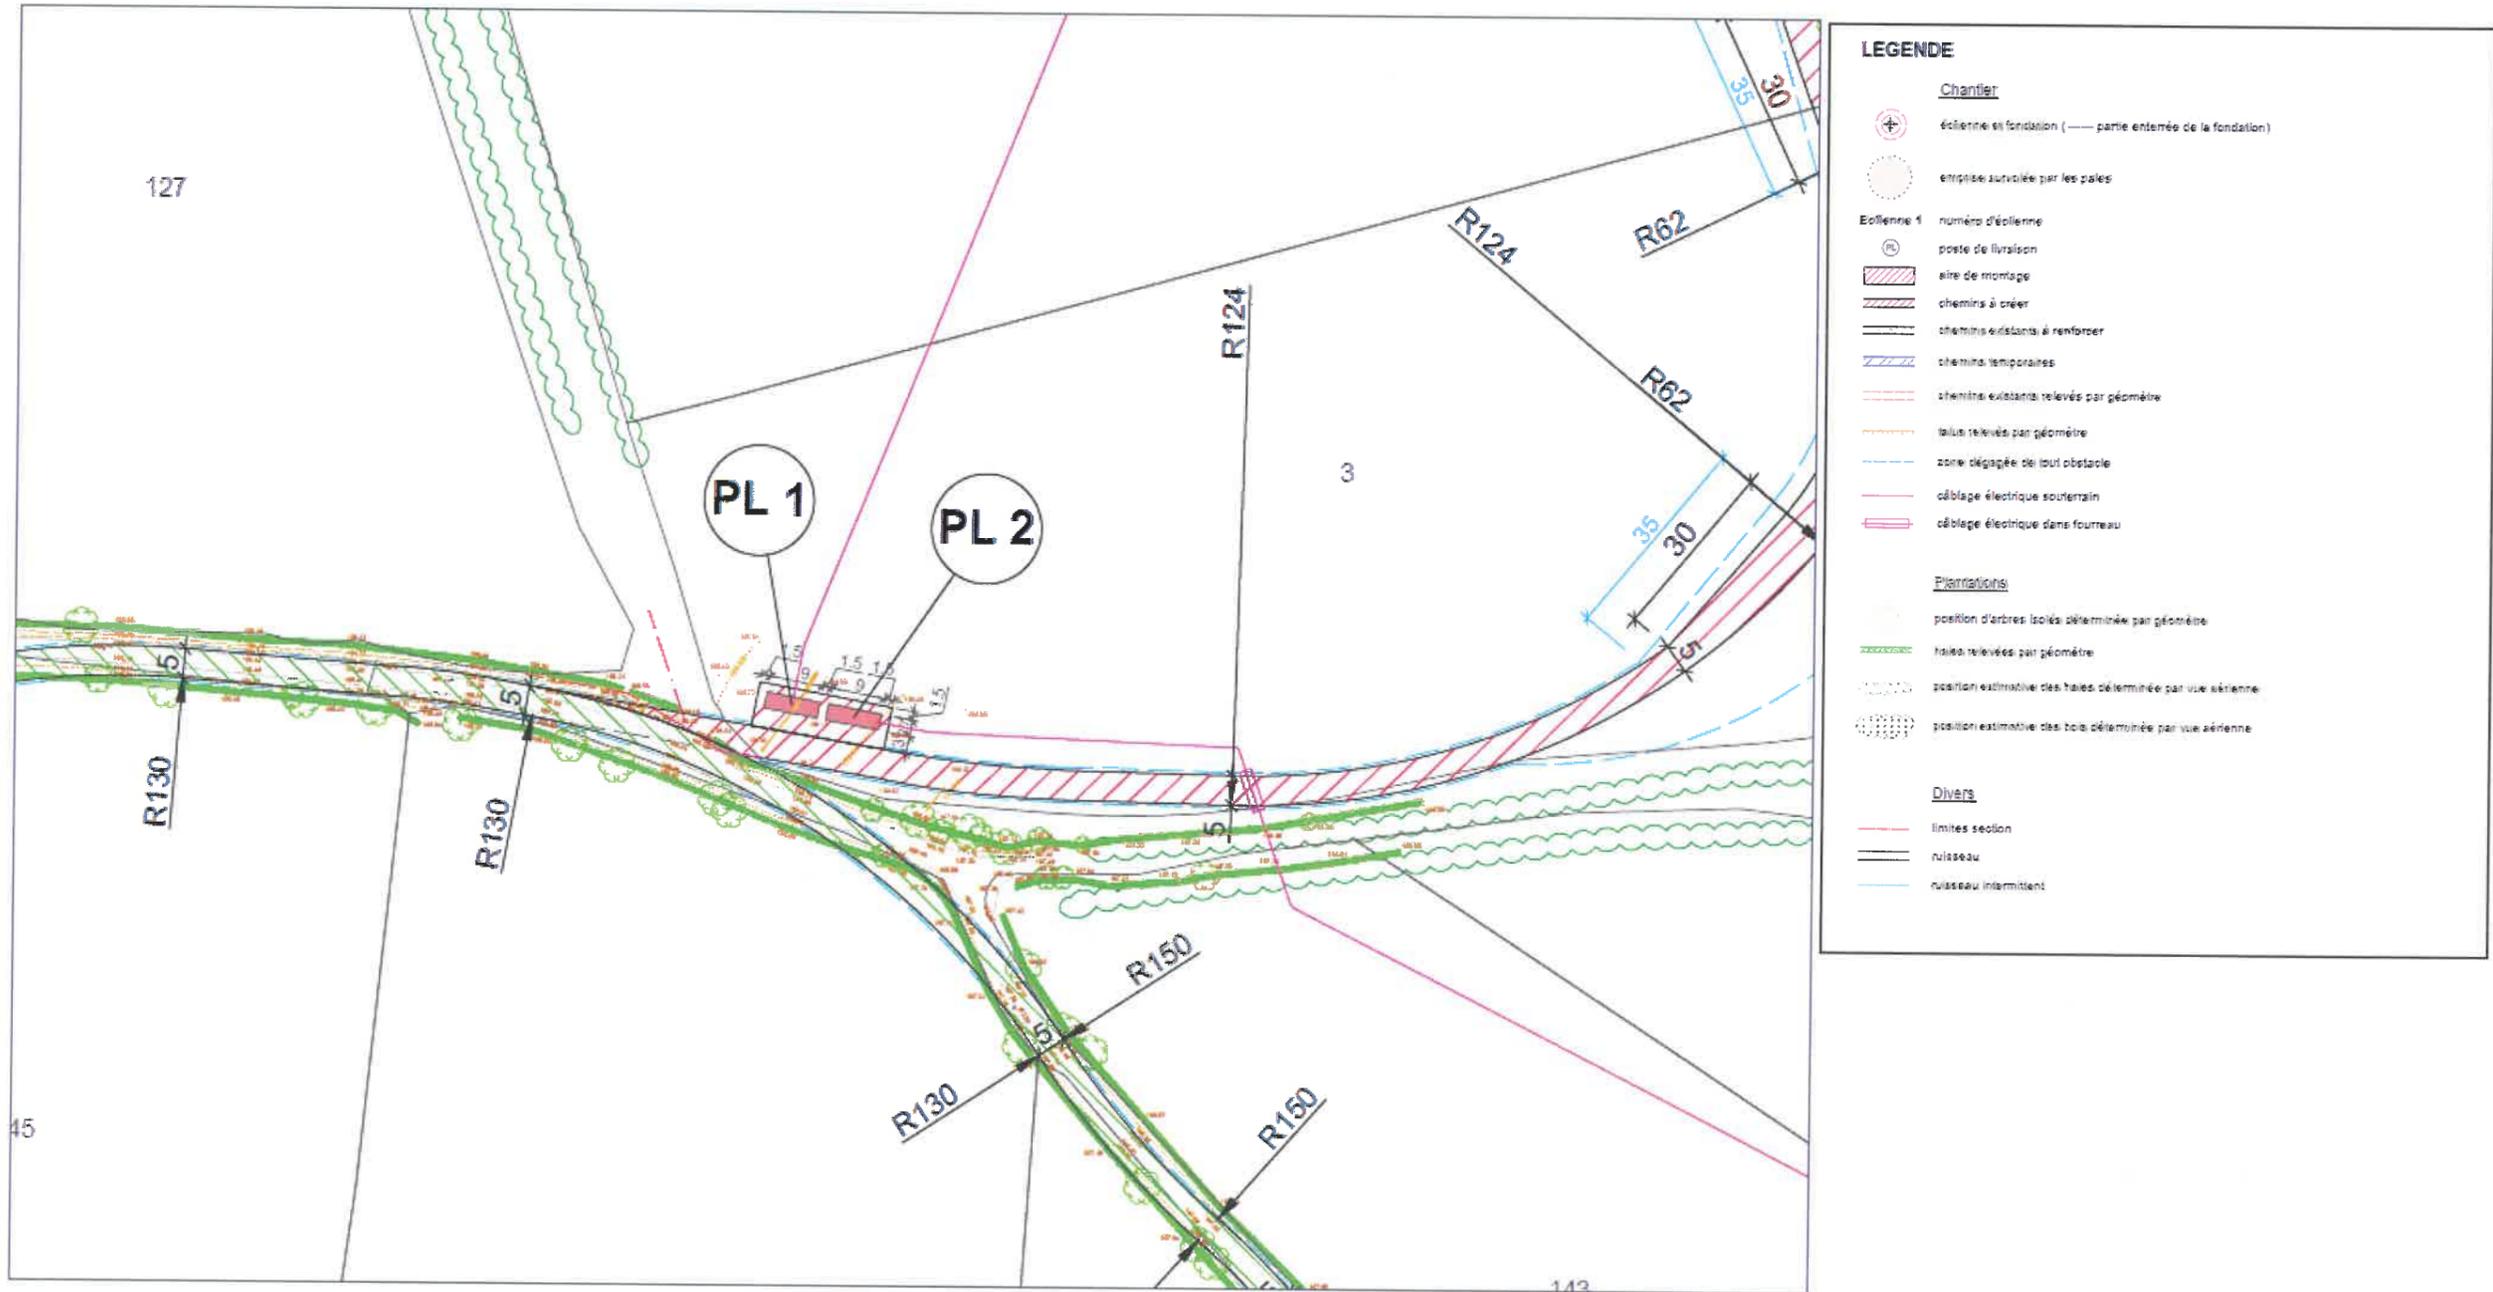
Plan de masse – Zoom sur les postes de livraison
